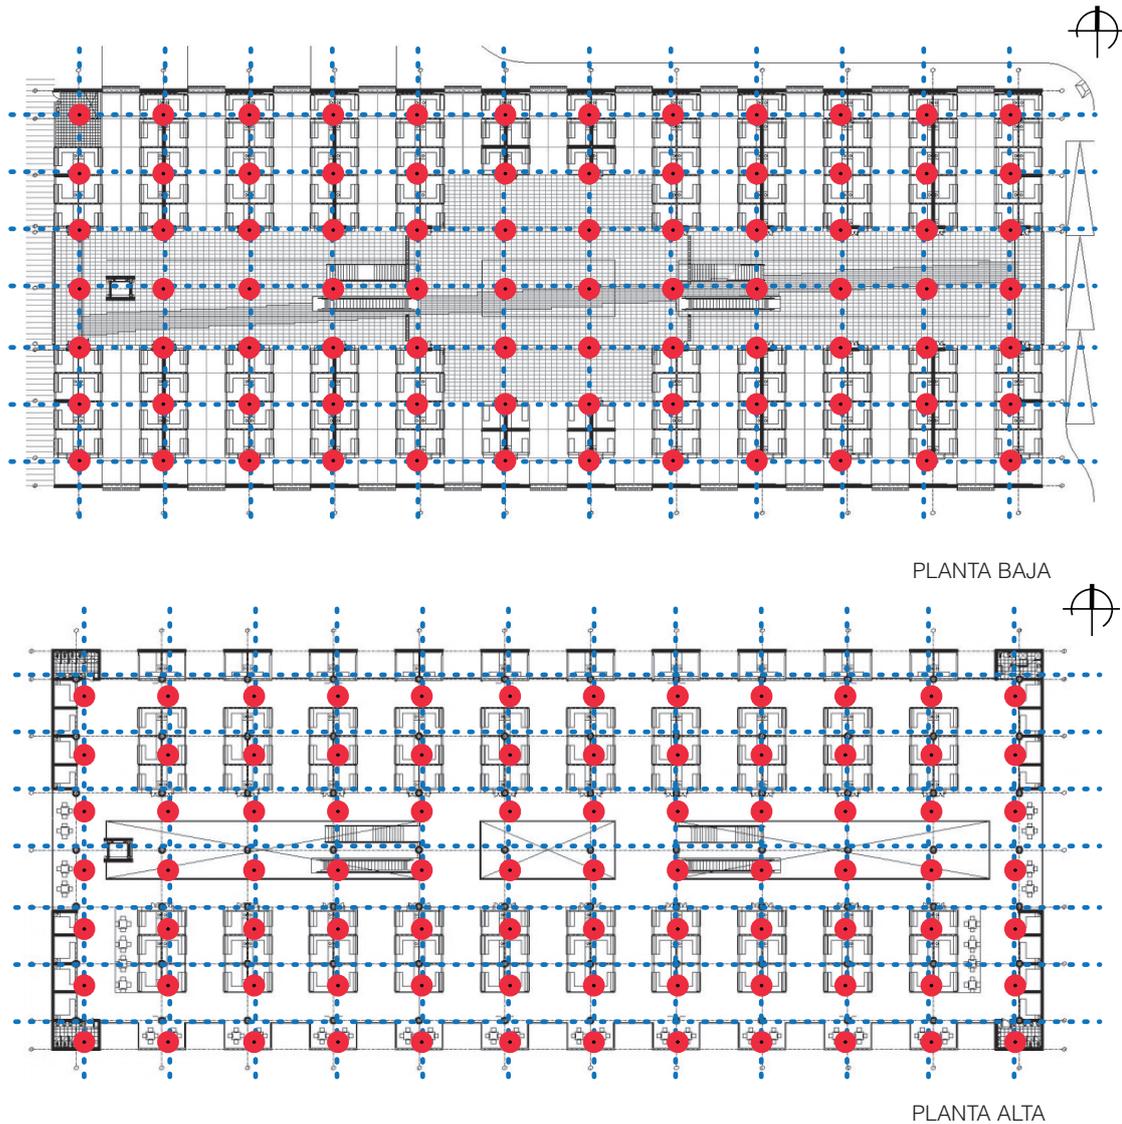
Planos del Mercado Tirso de Molina con análisis del sistema estructural. Foto. Pedro Mutis. Fuente: Archdaily y análisis de estructura de elaboración propia.
